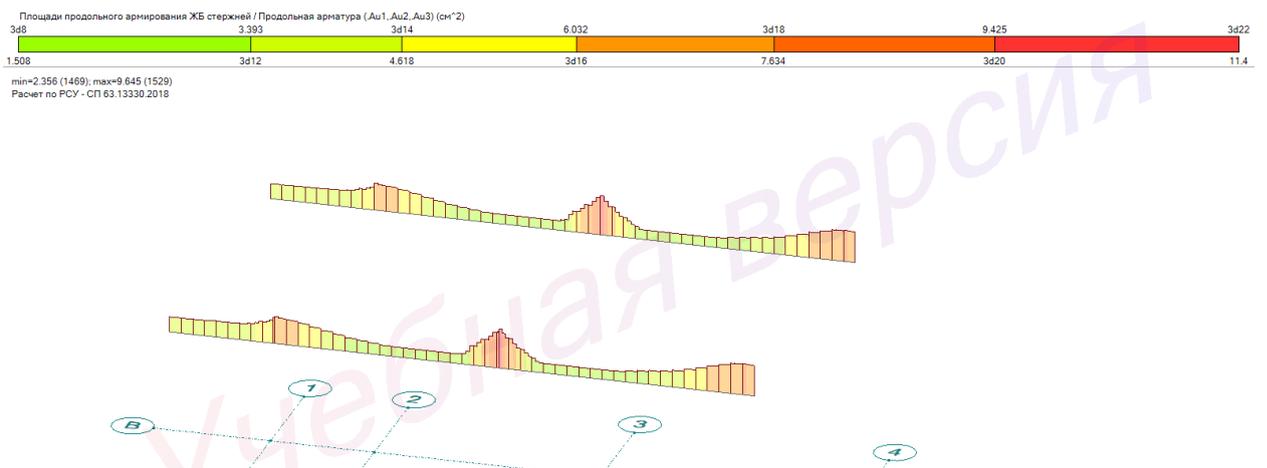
«армирование верхней зоны многопролетных балок» [11]
